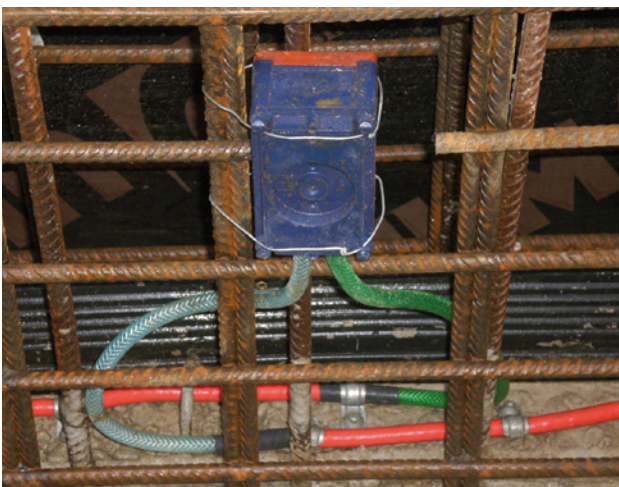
Fachgerechte Überlappung zweier Injektionsschlauchabschnitte
